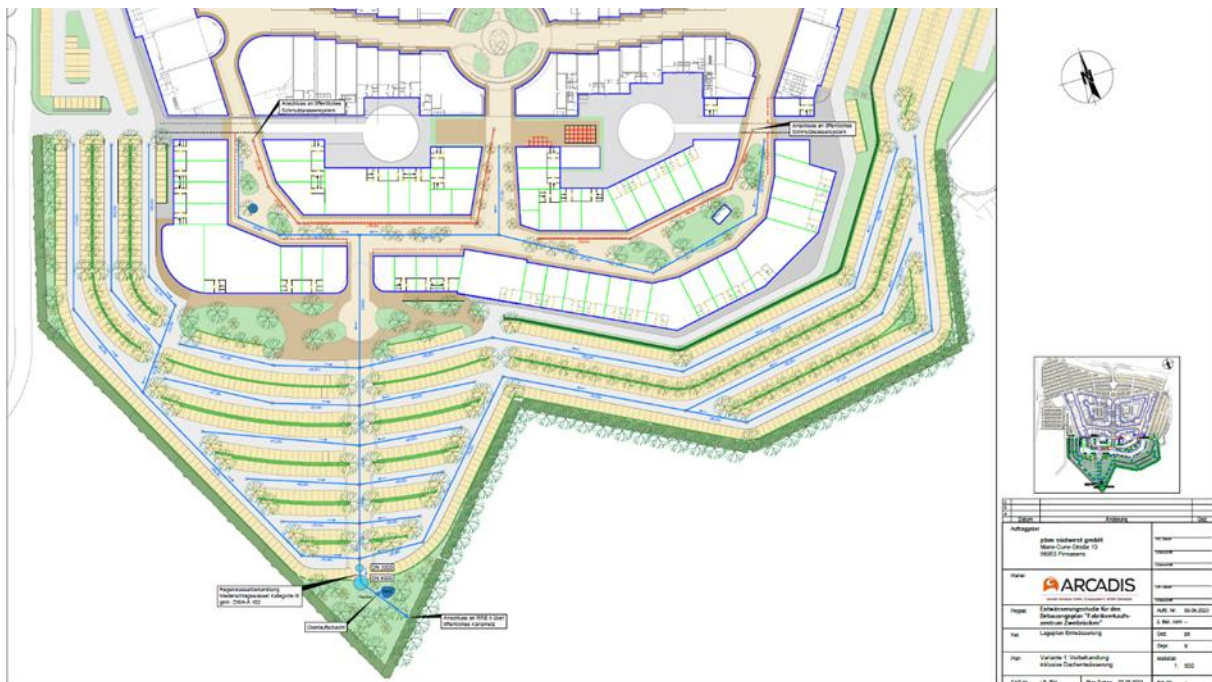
Lageplan Entwässerung: Variante 1: Vorbehandlung inklusive Dachentwässerung (ARCADIS, 2023; vgl. Anlage 10).
